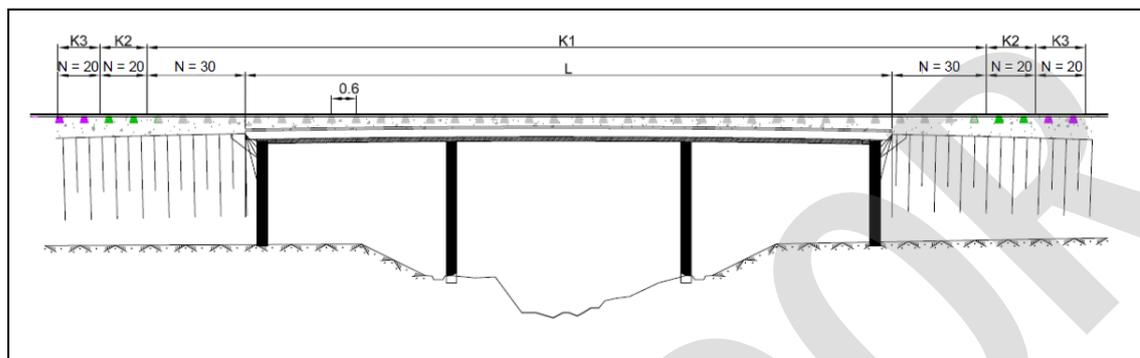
Esquema distribución de traviesas con suela en viaducto sin aparato de dilatación
